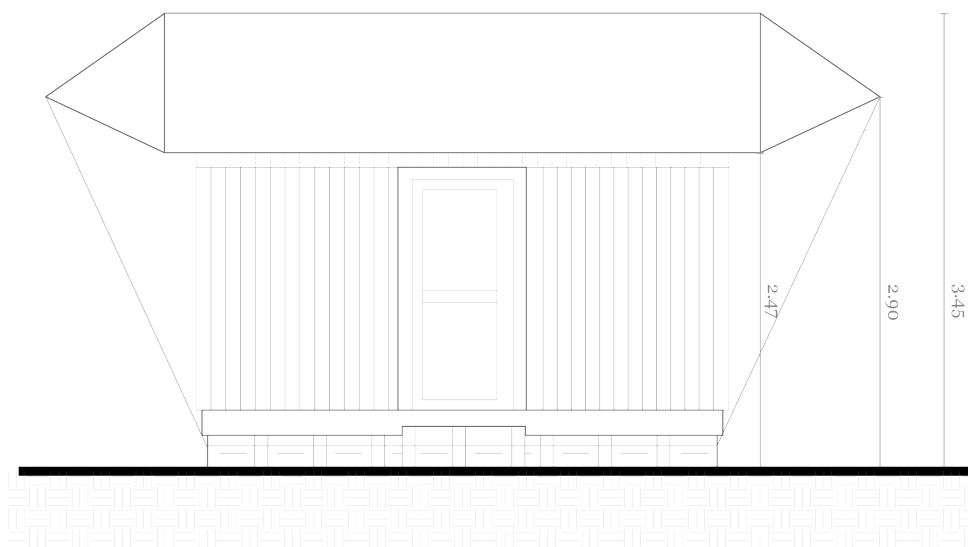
Elevación Frontal Paper Log House. Elaboración: Autores. Escala 1:50
